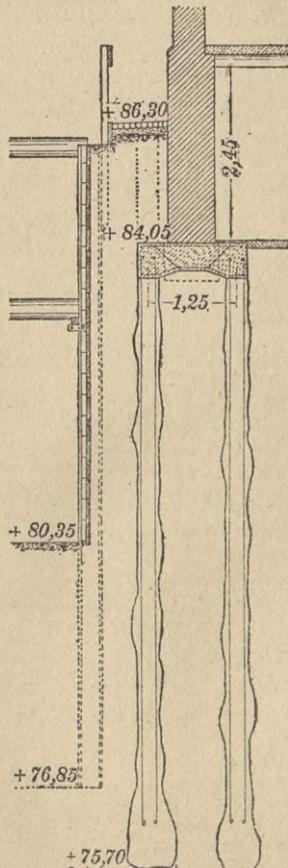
Unterfangen einer Gebäudemauer mit Eisenbetonbalken auf Ortpfählen.
